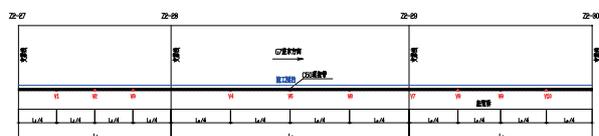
Z2 匝道第 3 联钢-混凝土组合连续梁振动参数测点布置示意图
